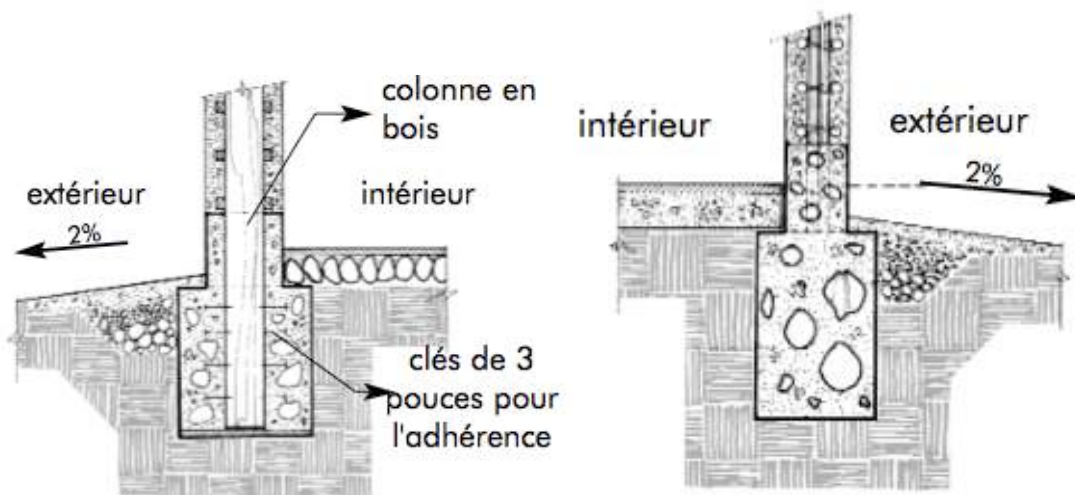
Fondation avec colonne encastrée dans le béton (a). Fondation en béton cyclopéen² (b) (Carazas, s.d.)
